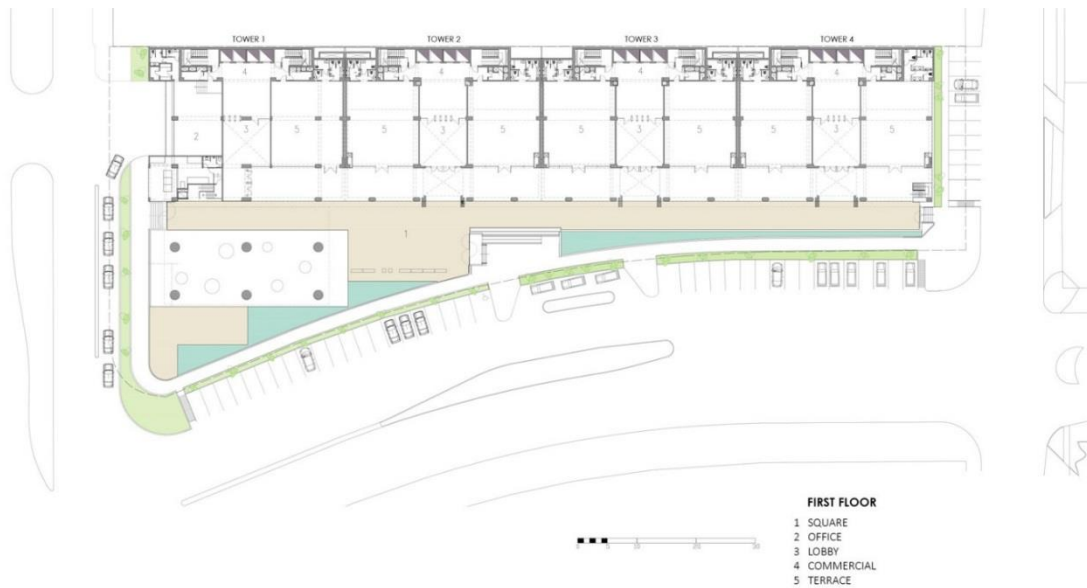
Primera planta comercial del Centro empresarial “Cronos”.
